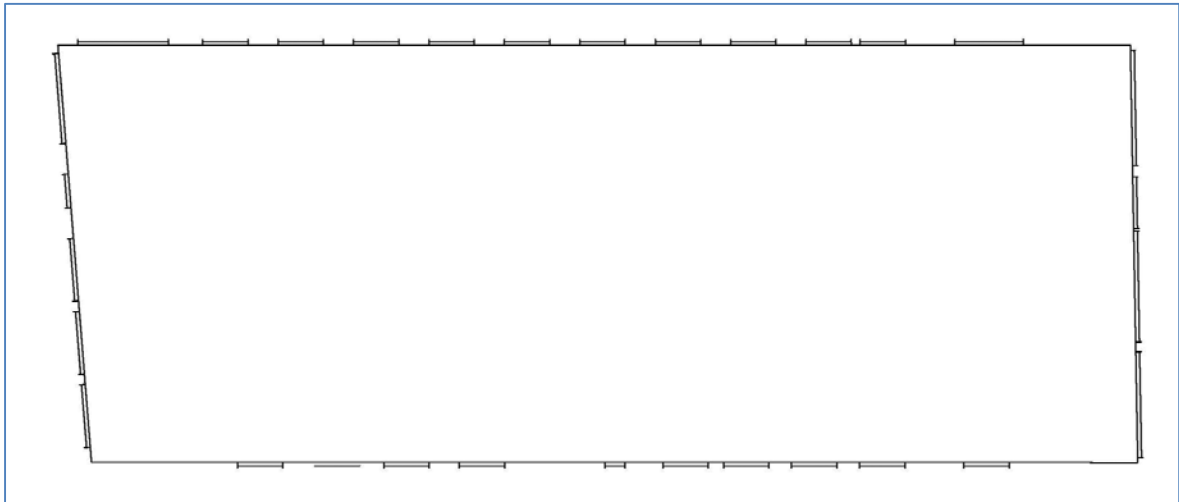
Silueta efectuada a partir del plano de planta baja del Proyecto de Ejecución. (Efectuada por la cara interior de la fachada).
